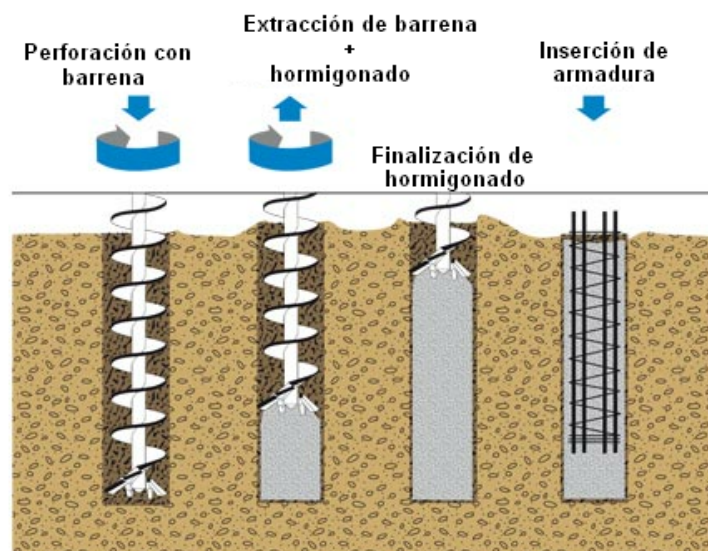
Procedimiento de construcción de un pilote CPI-8.
